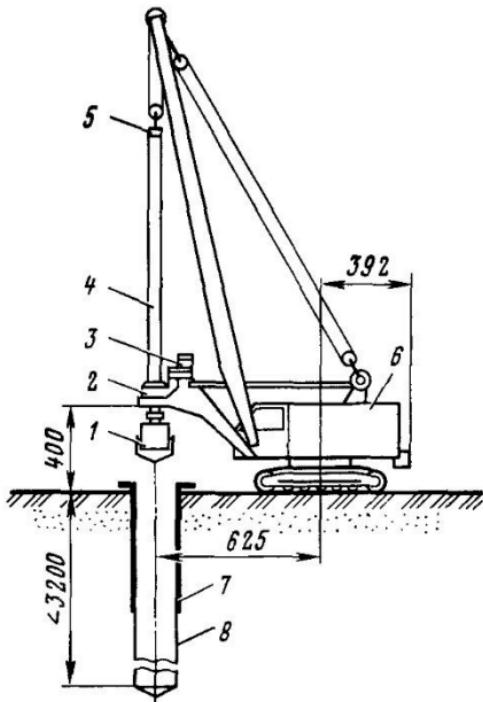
Навесное буровое оборудование МБУ-1,2:
